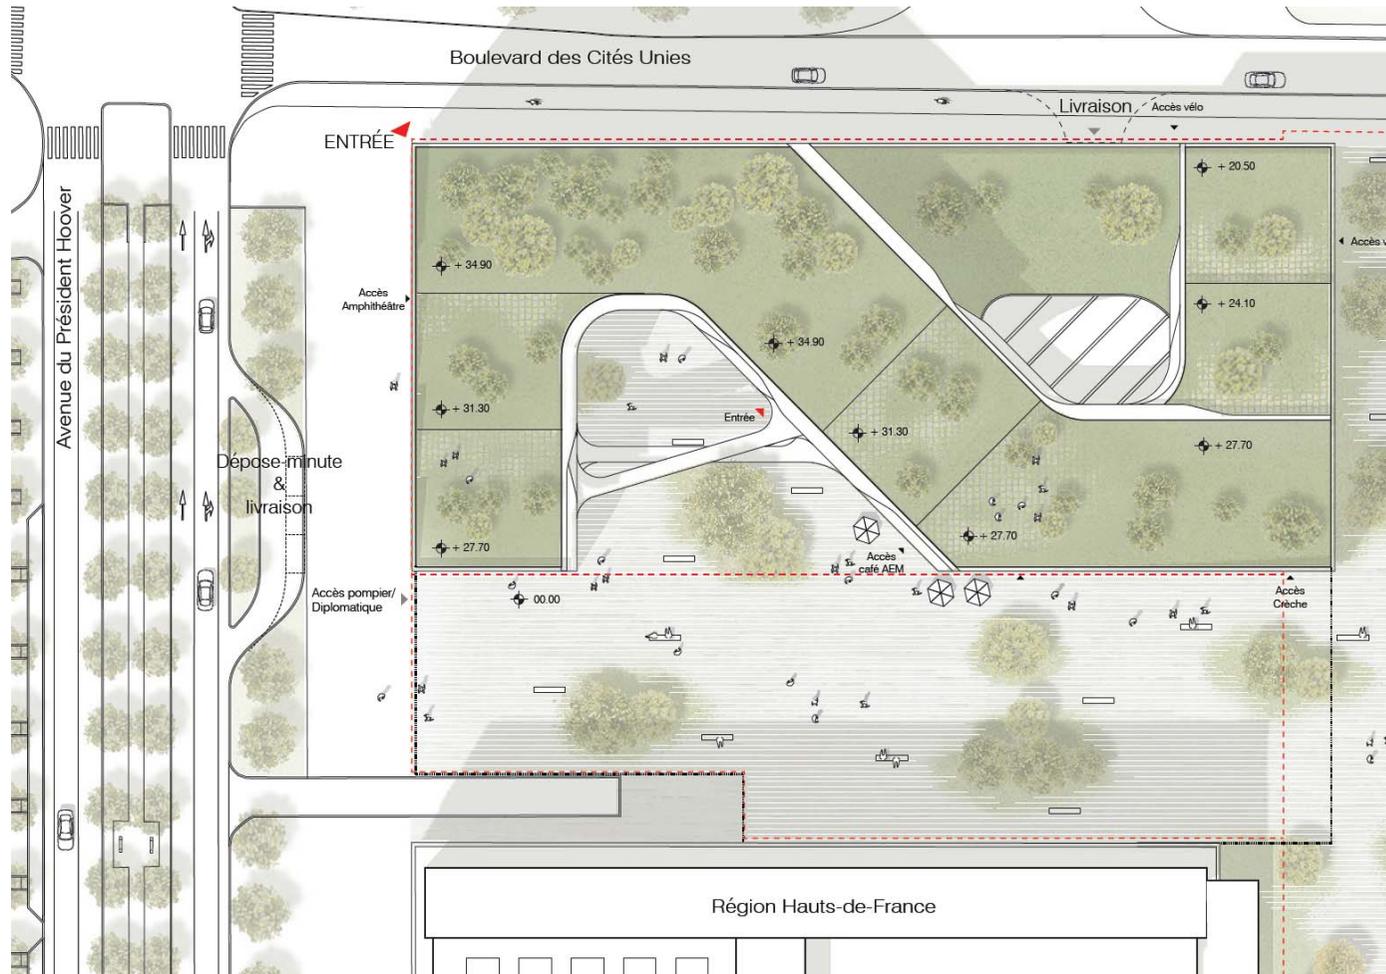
Plan masse du projet (Source : Linkcity)
